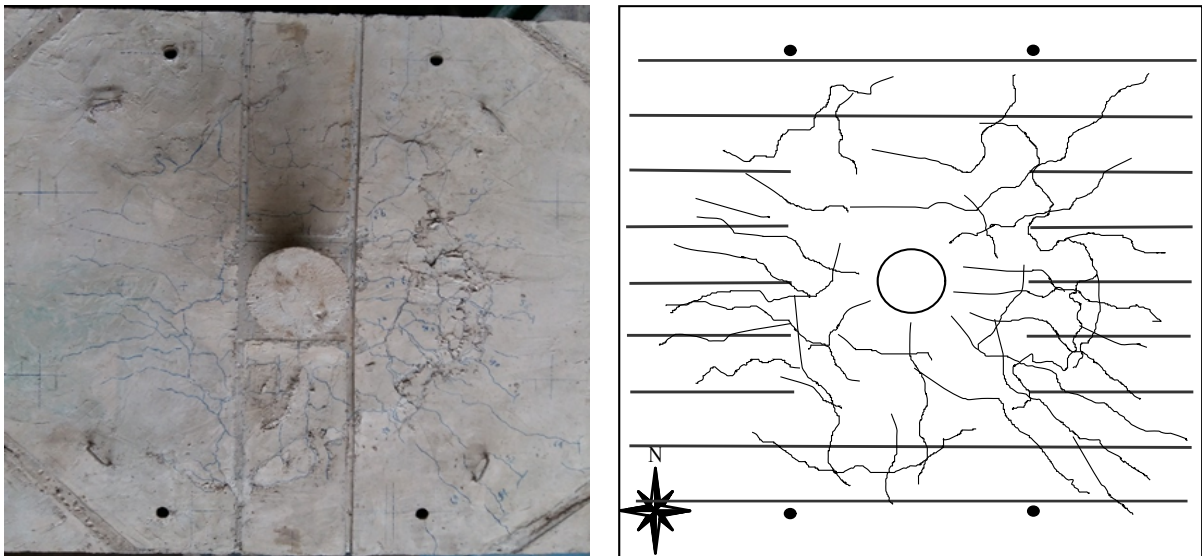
Mapa de fissuração - Laje BD-A04
